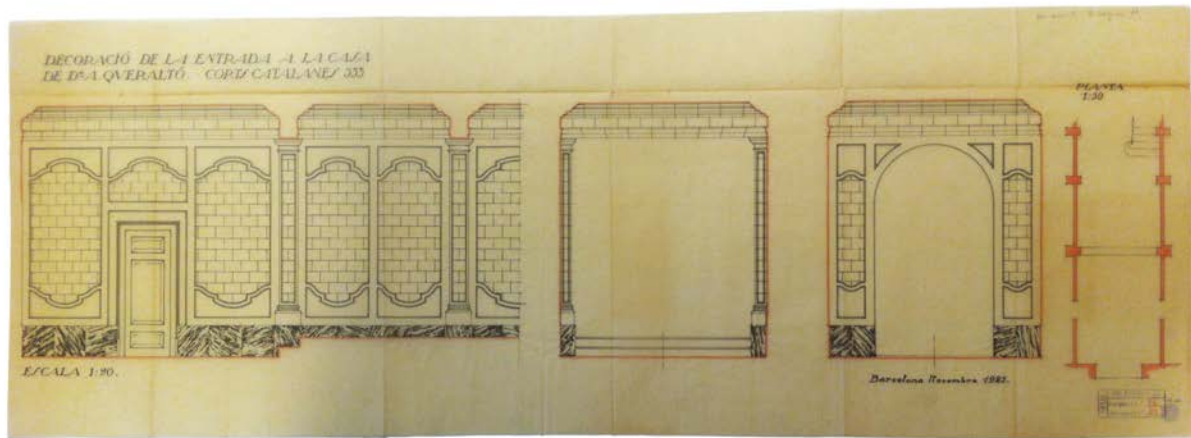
Seccions i planta de porteria (casa Assumpció Queraltó, Pere Benavent, 1924). Font: AHCOAC H109A/1/23.
